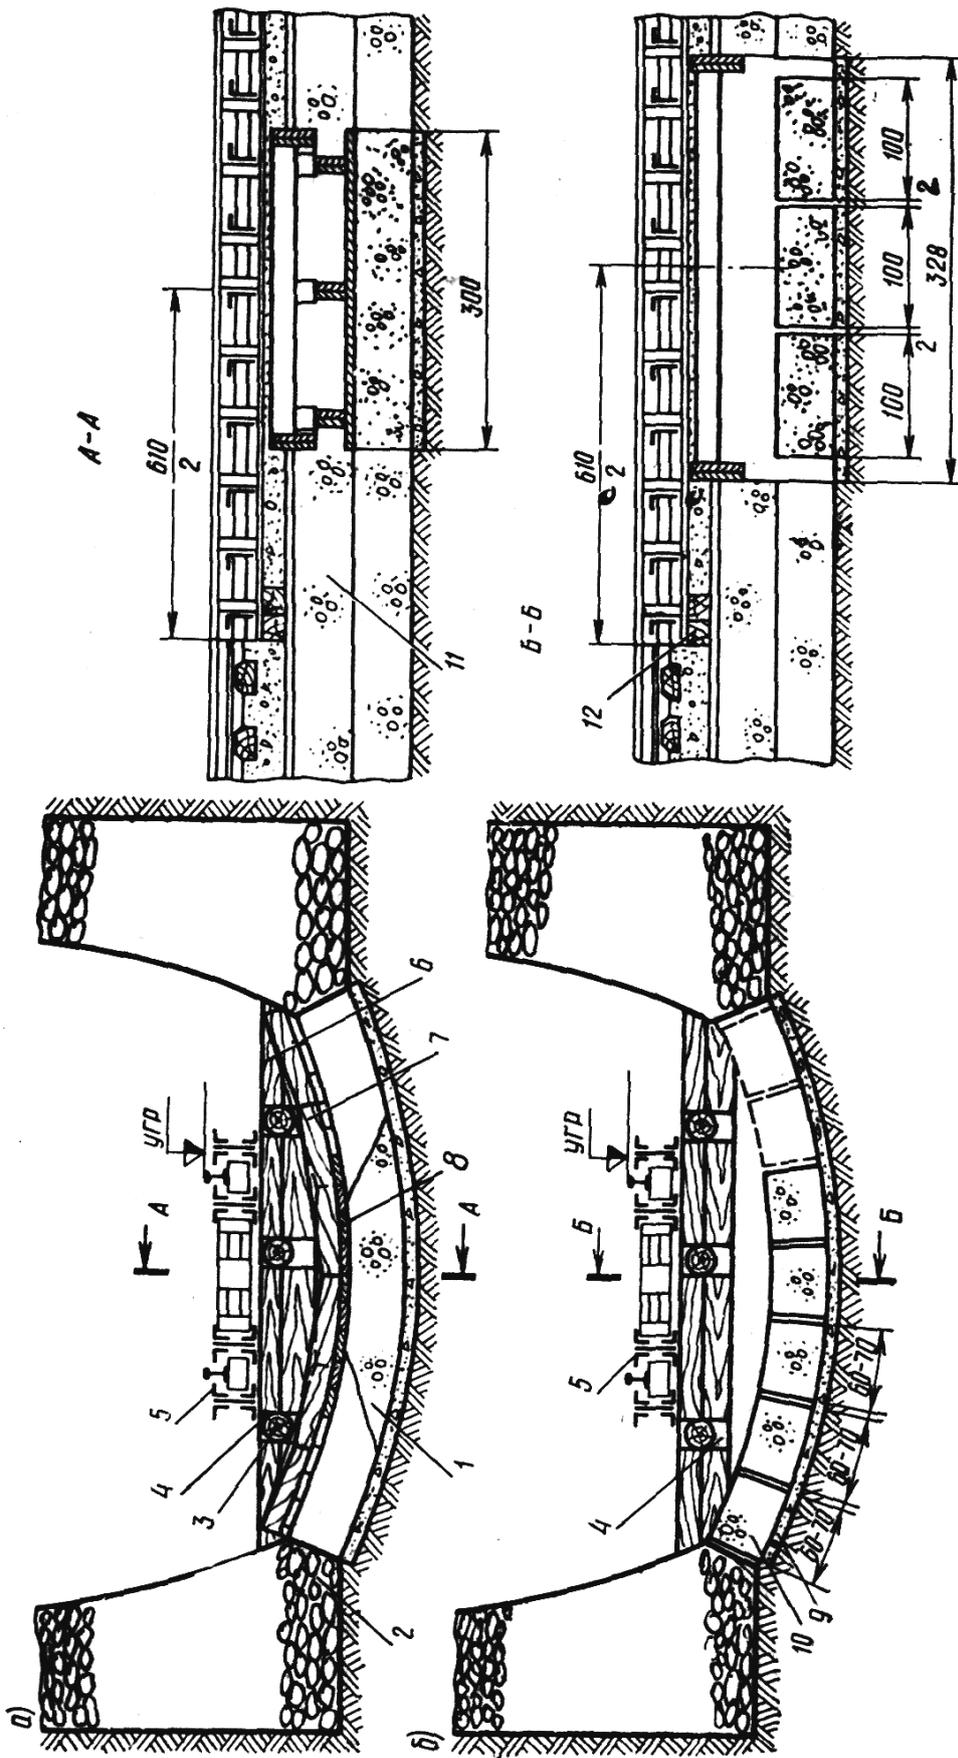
Перекладка обратного свода: а – свод из монолитного бетона; б – свод из сборного бетона; 1 – вновь уложенный бетон; 2 – старая кладка; 3 – расстрелы; 4 – схватки из двух досок; 5 – подвесной пакет; 6 – боковая затяжка из досок; 7 – лекала из двух досок; 8 – опалубка; 9 – щебеночная подготовка; 10 – сборный бетон; 11 – тощий бетон заполнения; 12 – опорные брусья
